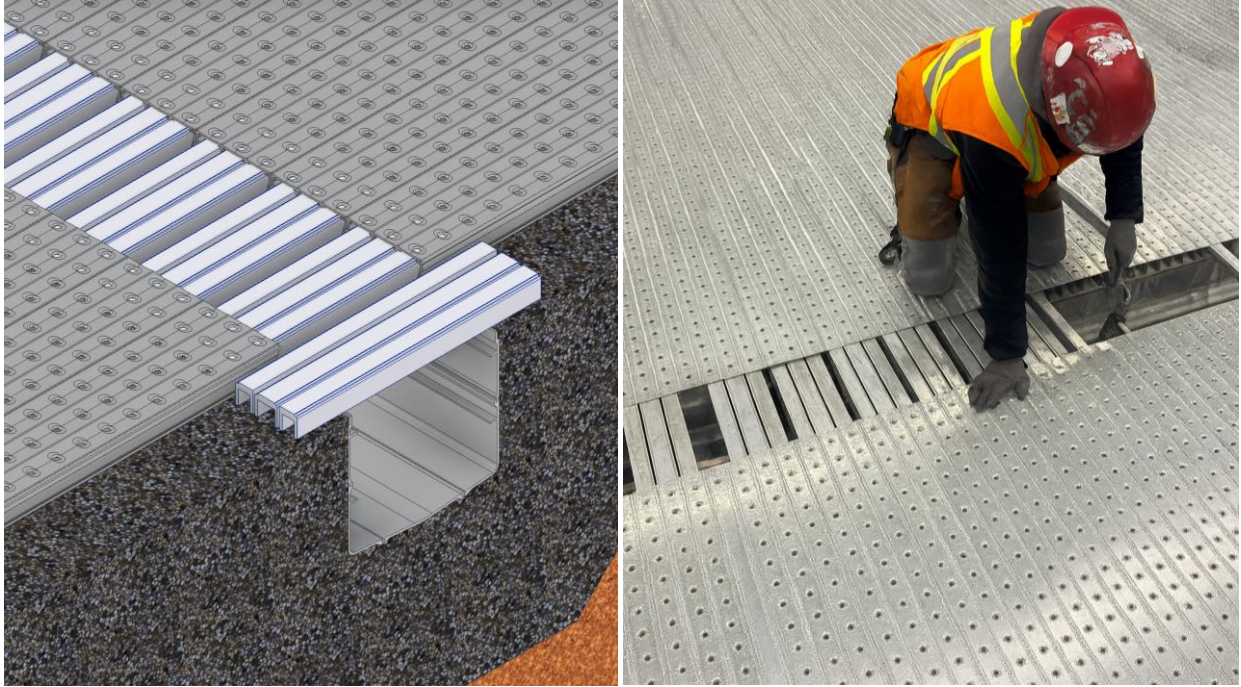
(Gauche) Rendu montrant les poutrelles supportant le couvercle de caniveau. Les premiers profils et le couvercle sont retirés pour révéler les supports. (Droite) Poutrelles de support installées sur site
